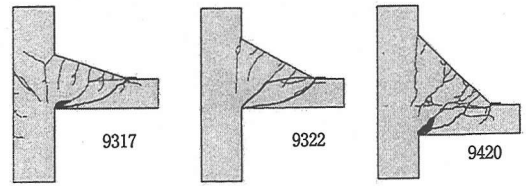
TYPE-III ①試験体(ハンチ筋あり)のひび割れ発生状況
